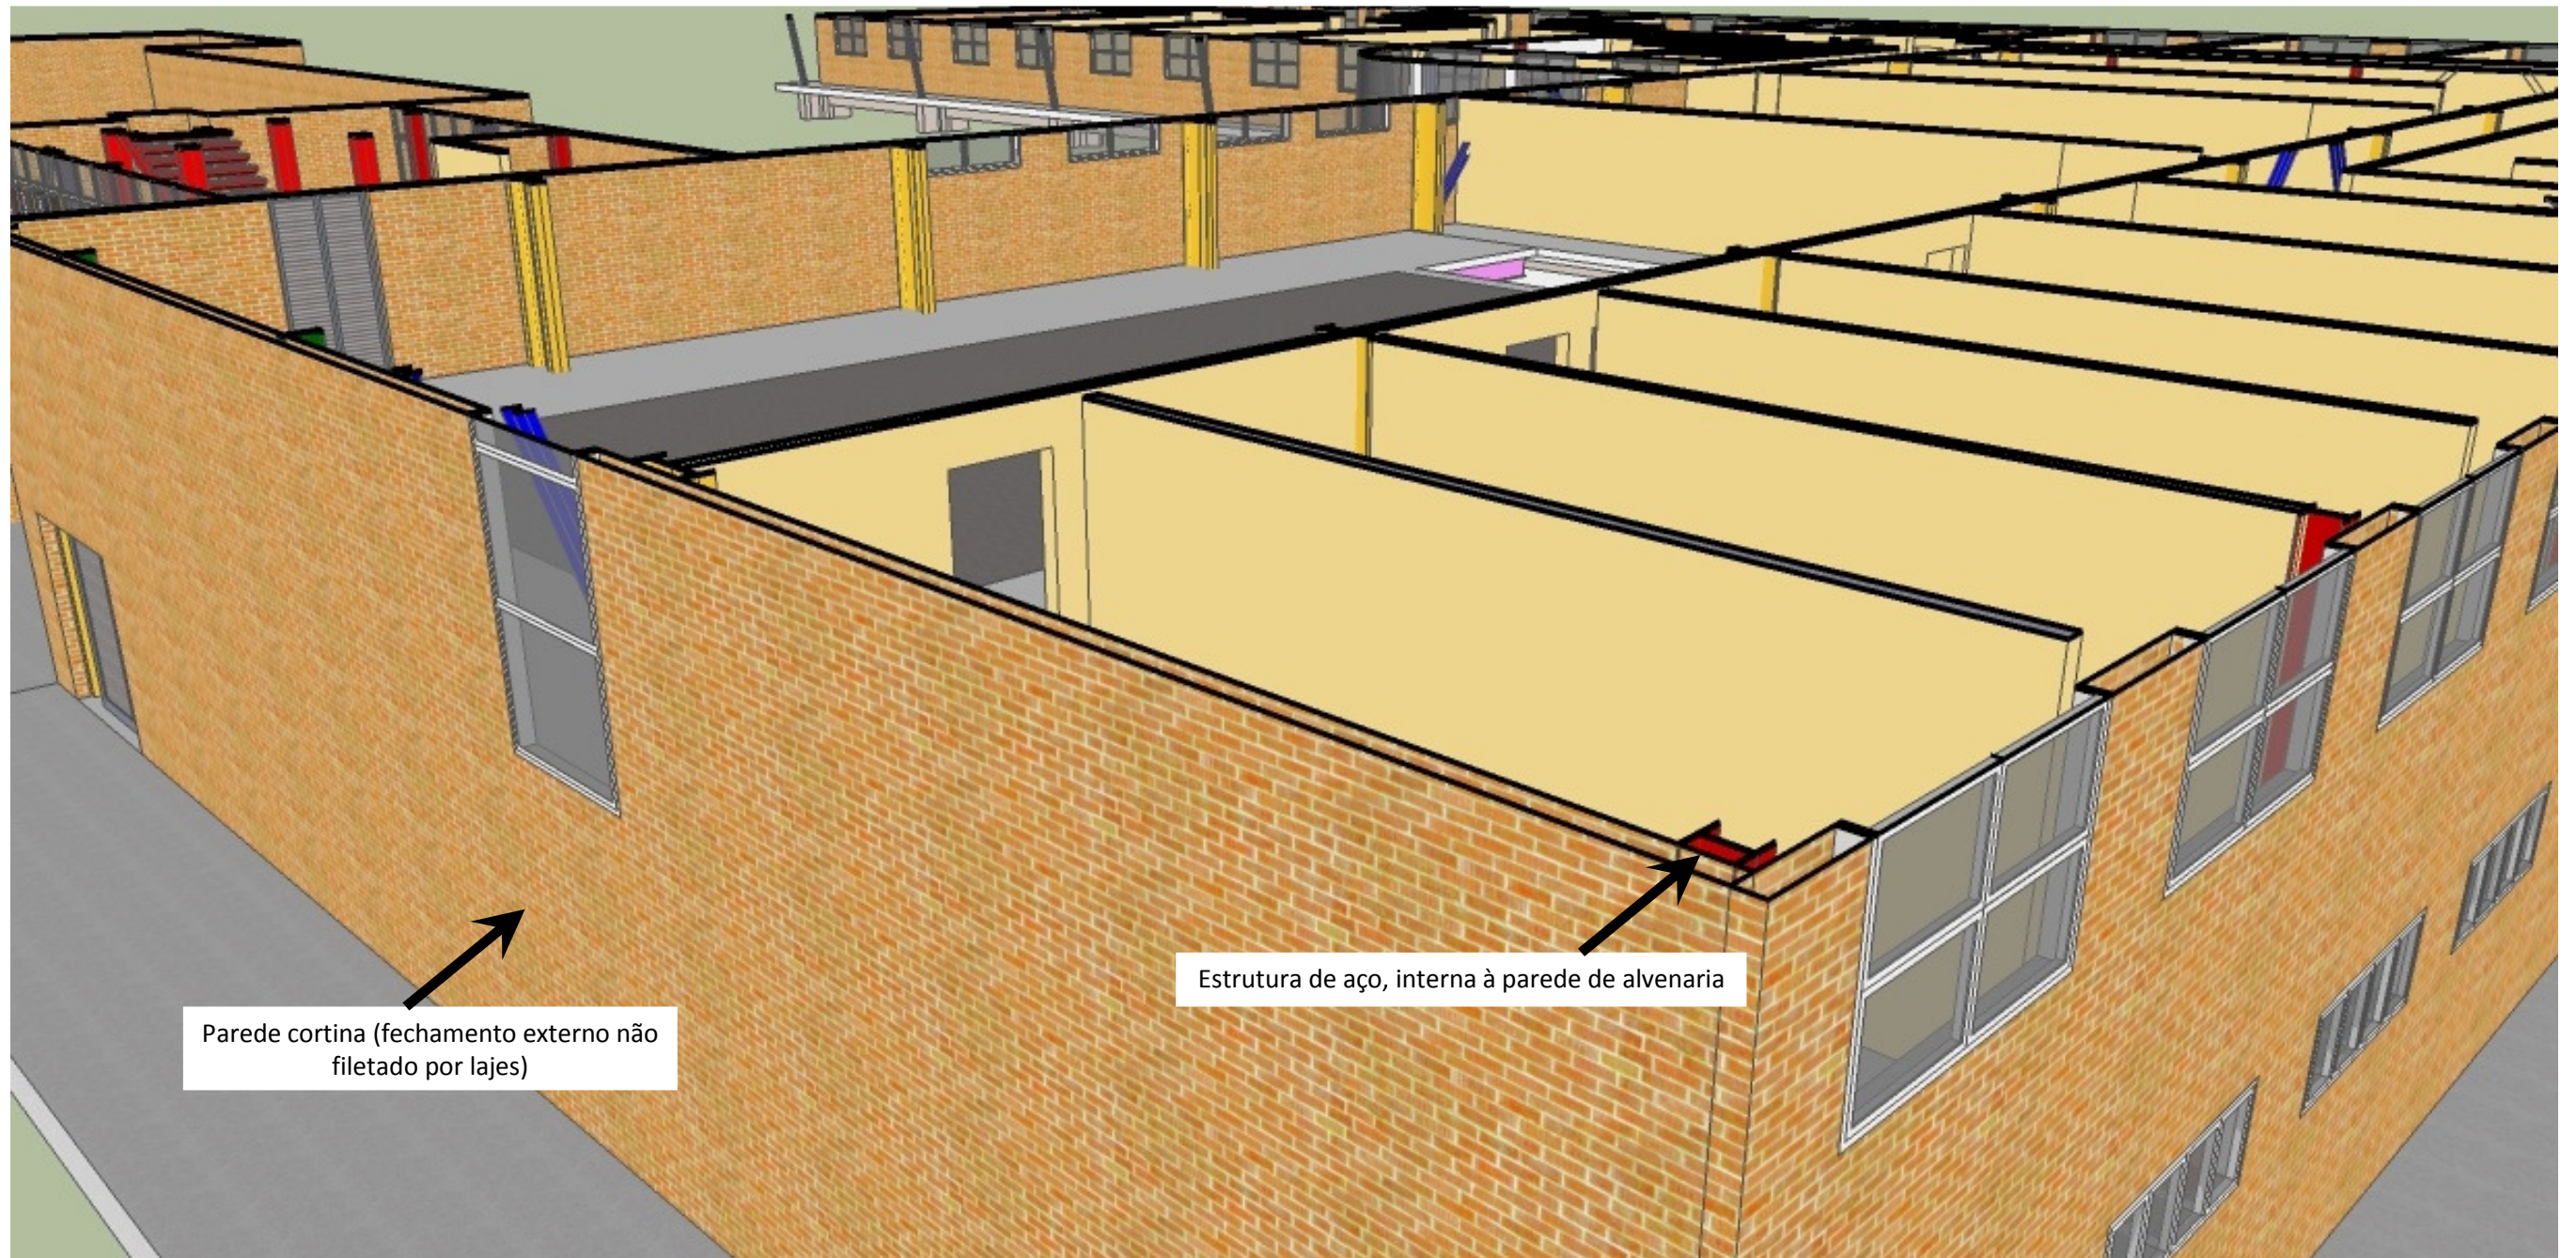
Perspectiva do pavimento 01 mostrando alvenaria em relação à estrutura de aço.
